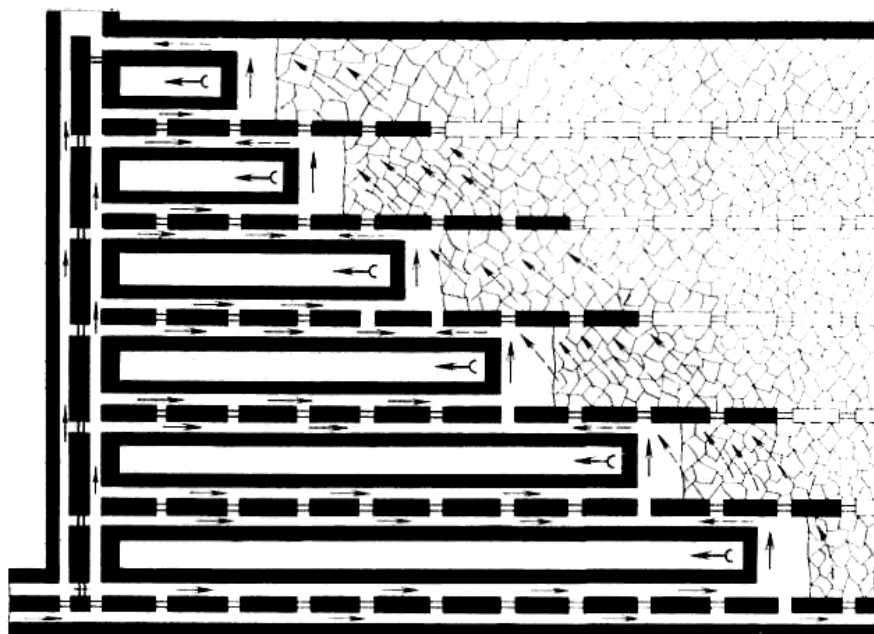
Схема вентиляции выемочного участка при разработке мощных крутых пластов длинными столбами по простиранию
